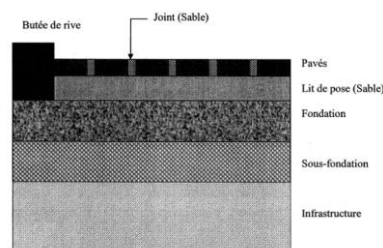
Coupe schématique d'une chaussée revêtue des pavés [10]
